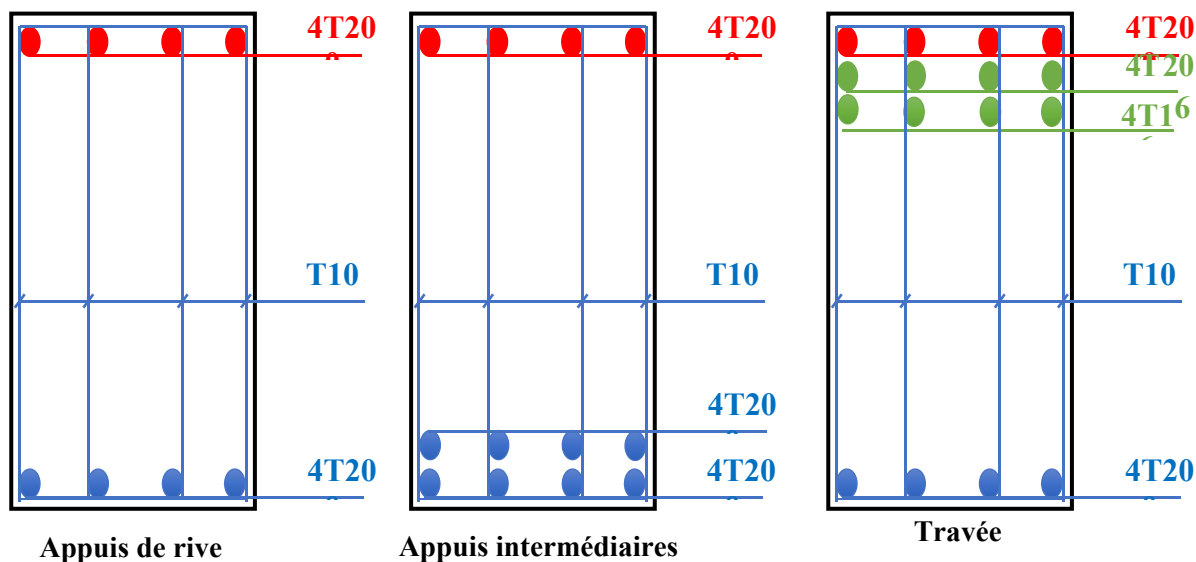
Ferrailage de la poutre de libage (sens longitudinal)
